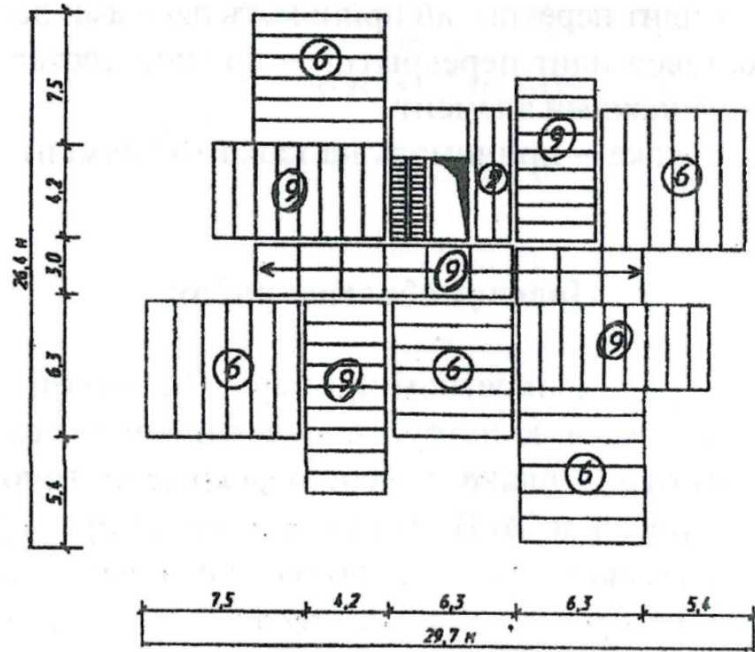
План перекрытия типового этажа: (6) - панели перекрытий площадью до 10 м^2 ; (9) – то же площадью 5 м^2
